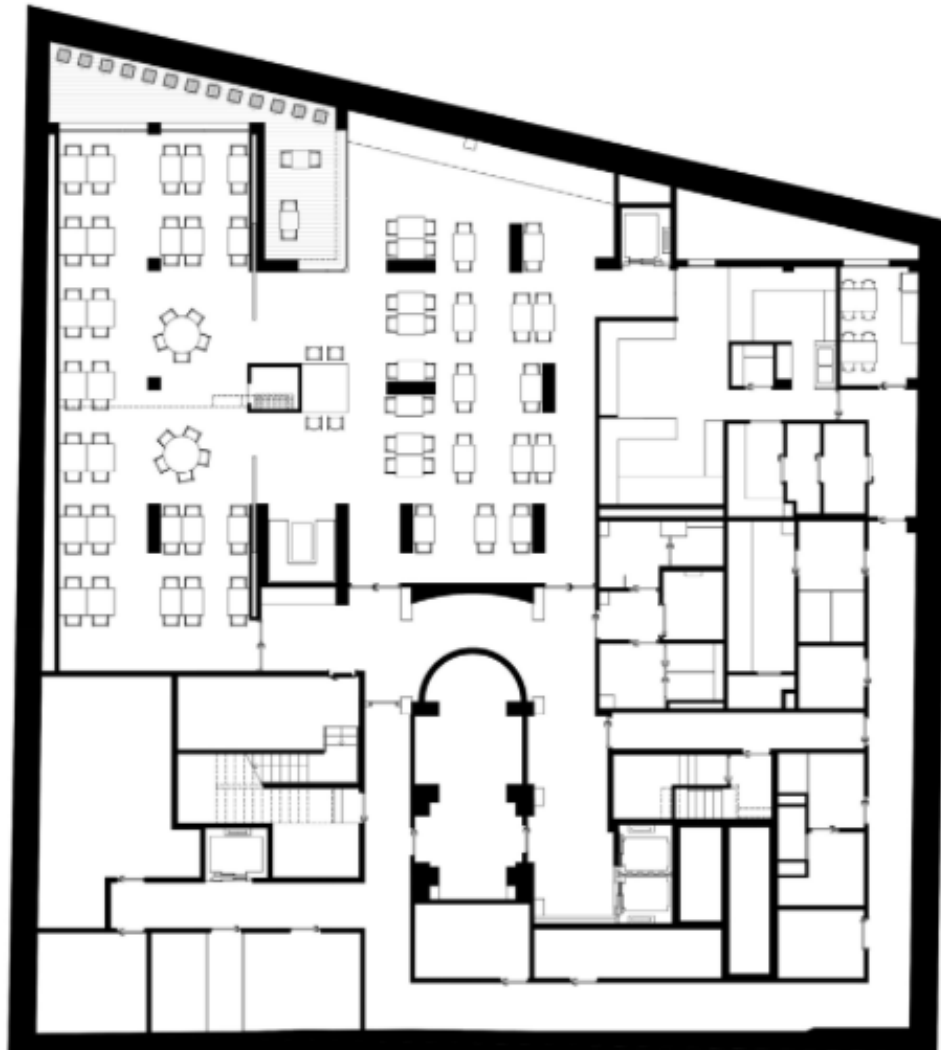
Planta do piso - I do Hotel Vincci Gala, sem escala nem Norte
